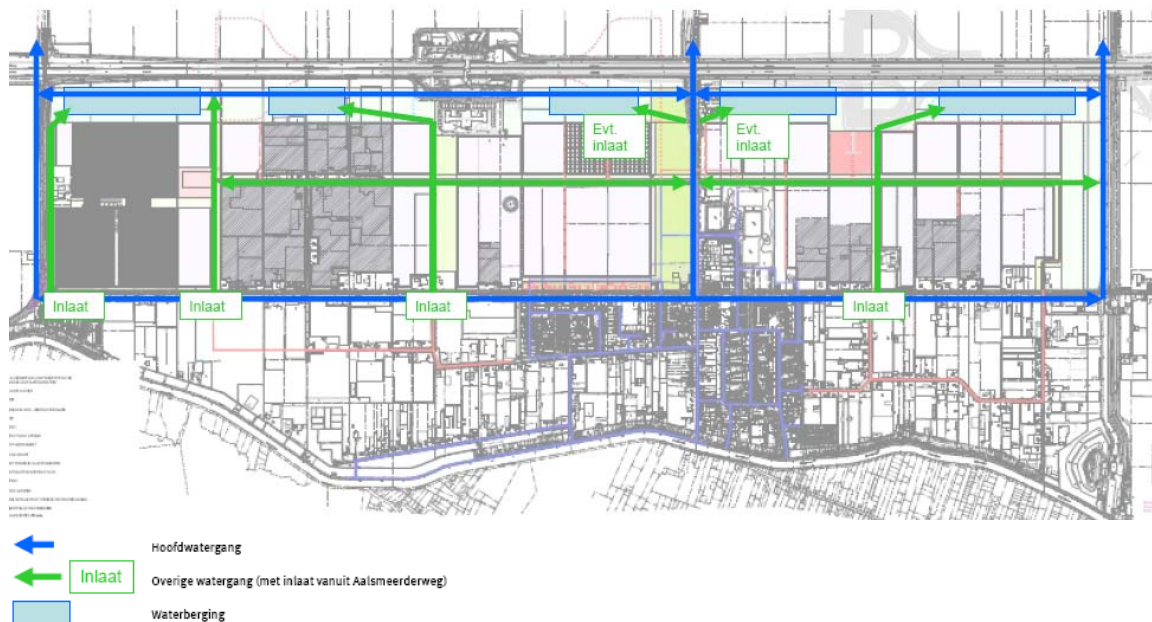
Waterstructuur Masterplan PrimAviera
